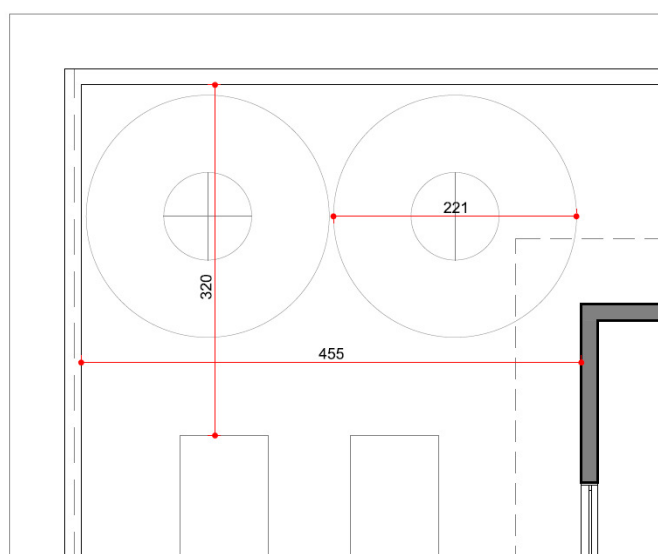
Planta baixa Área 1 com dois reservatórios de 11.000 litros
